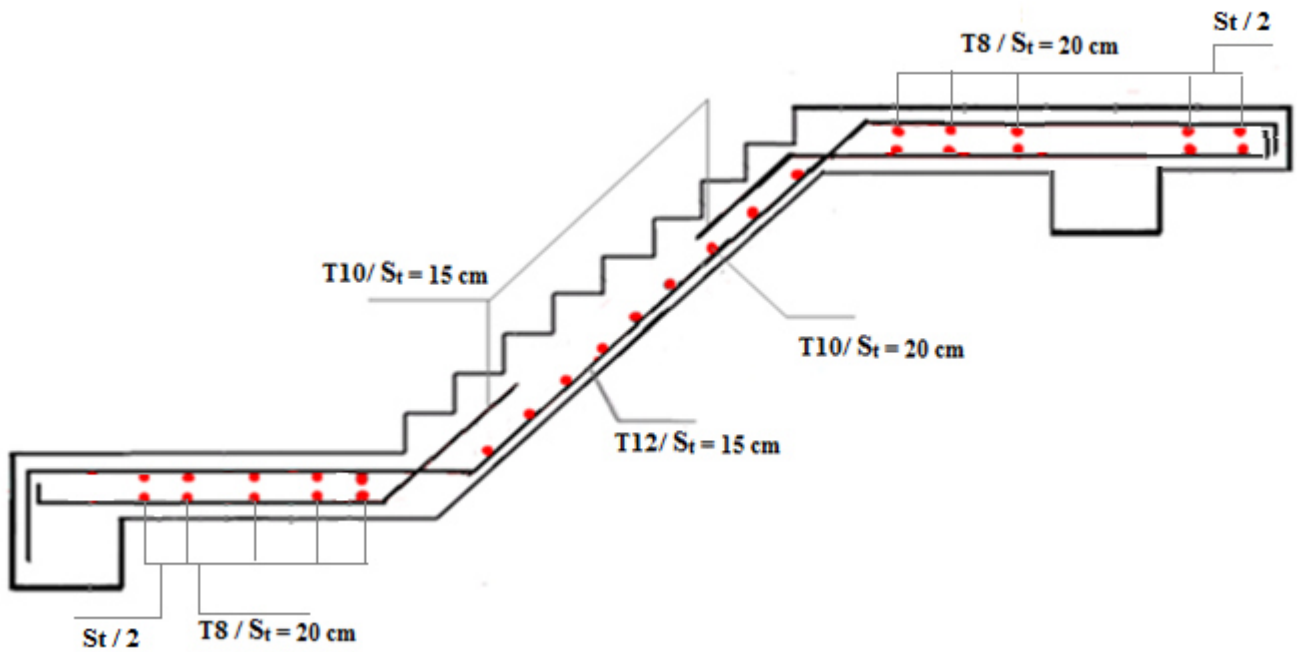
Schéma de ferrailage des escaliers étages courants.
